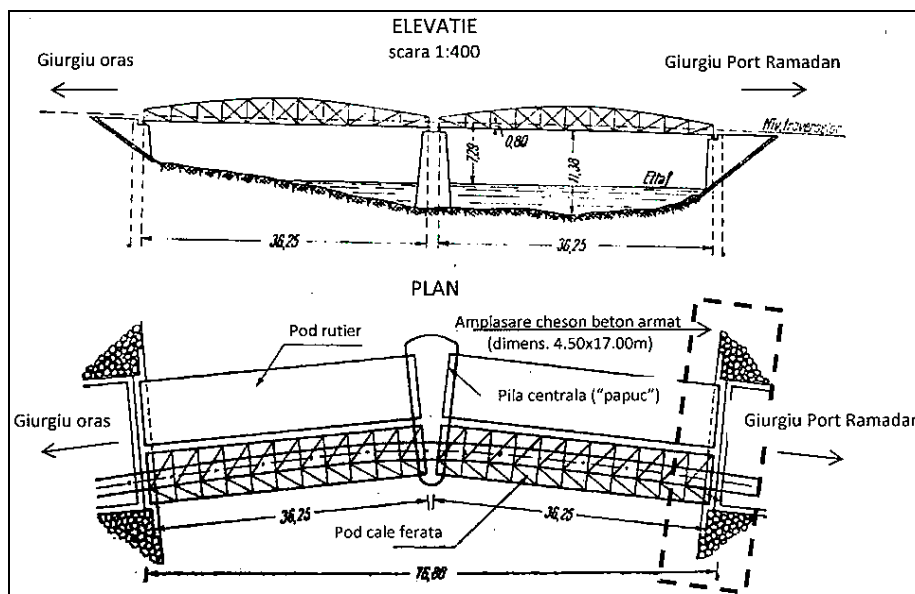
Podul metalic peste Canalul navigabil Sf. Gheorghe din Giurgiu. Plan și elevație (sc. 1:400)²⁴.
